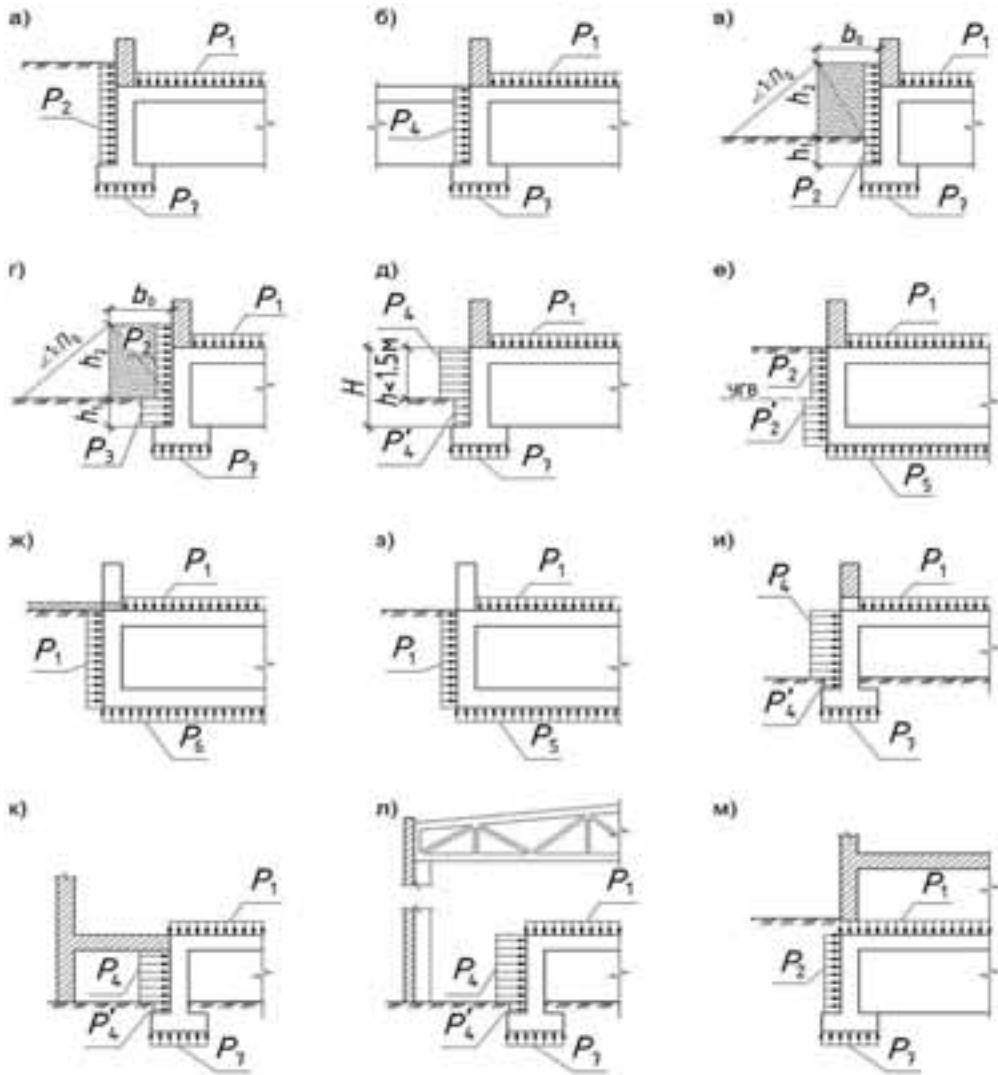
Схемы приложения динамических нагрузок на конструкции убежищ
